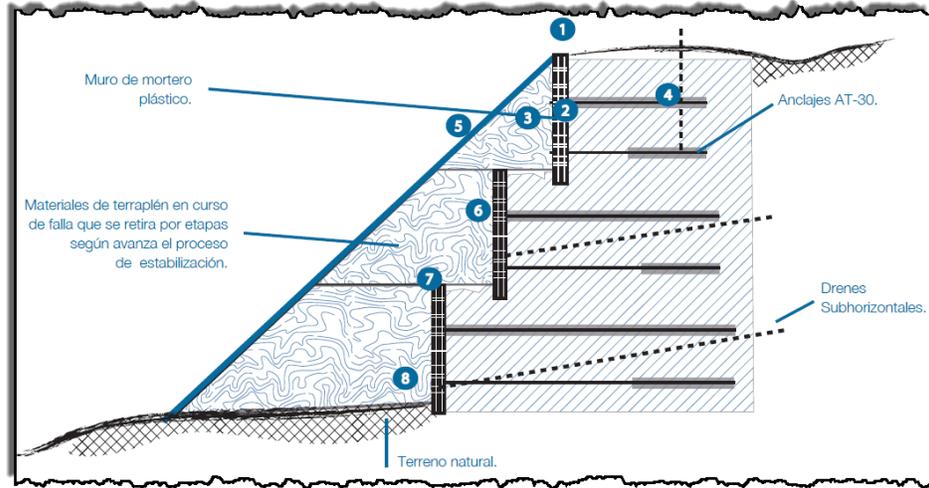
Procedimiento constructivo del sistema ESTATEC.
